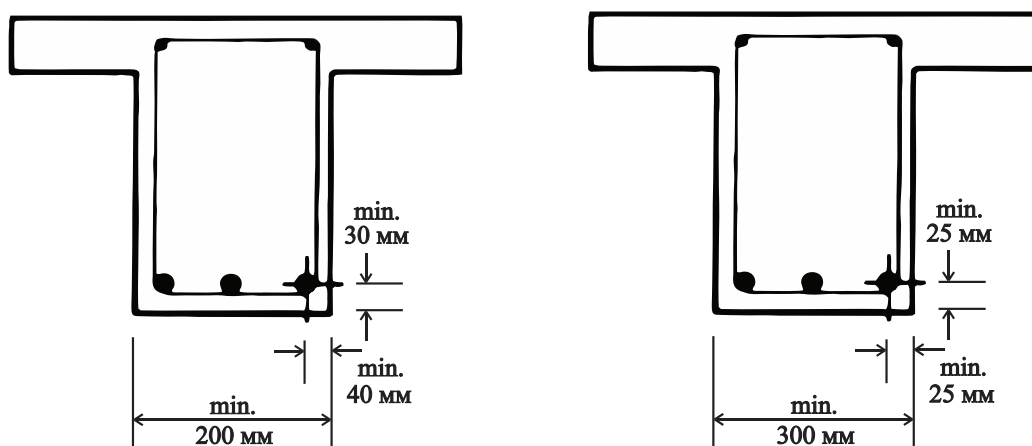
Два варианта армирования балки для обеспечения огнестойкости R60
